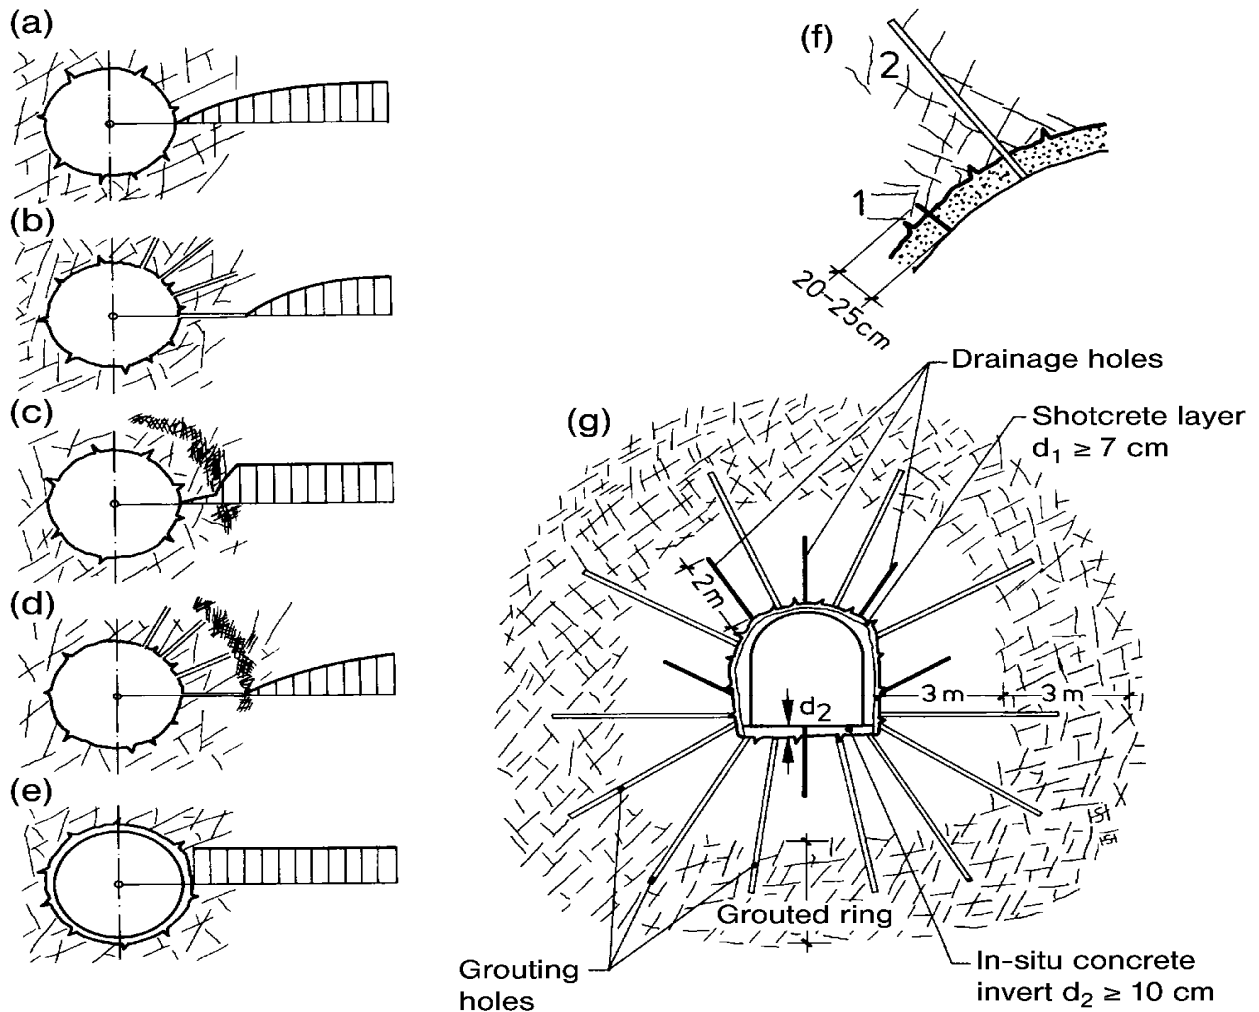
Distribución de la presión hidráulica alrededor de la excavación.
